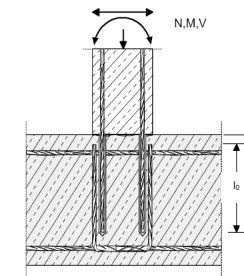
giunzione per sovrapposizione di pilastri sollecitati a flessione o muri a fondazioni.
